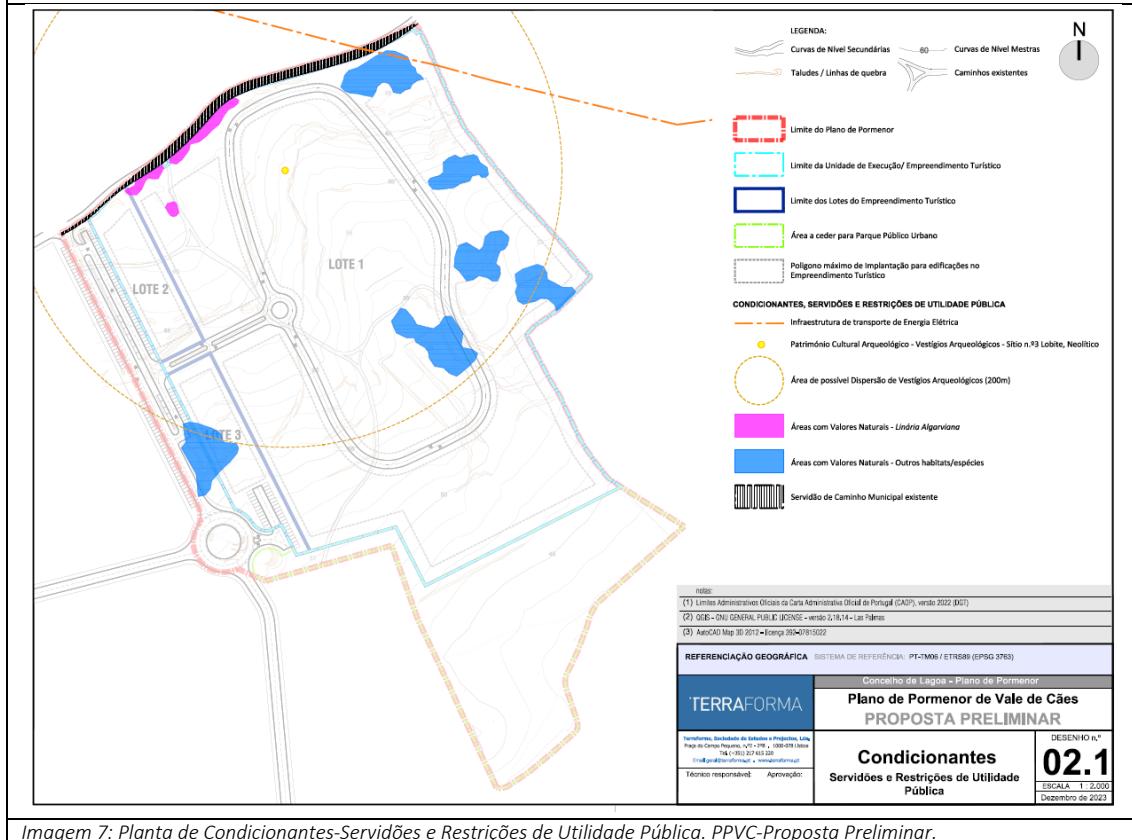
Planta de Condicionantes-Serviços e Restrições de Utilidade Pública. PPVC-Proposta Preliminar.
